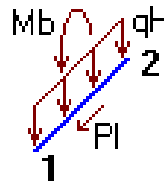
Напрямок дії навантажень на фундаменти
